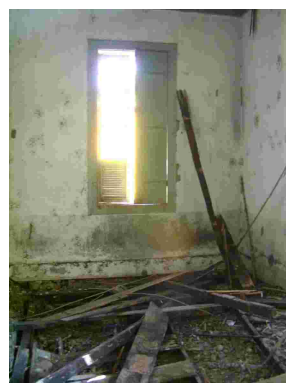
Detalhe do piso em tabuado de madeira da Estação de Antonio Rocha.
